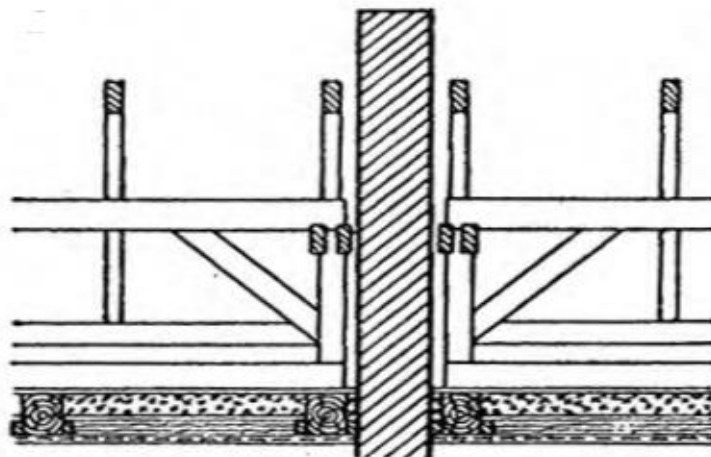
Сопряжение деревянных конструкций крыши с противопожарной стеной: прогоны опираются на подкосы и стойки
